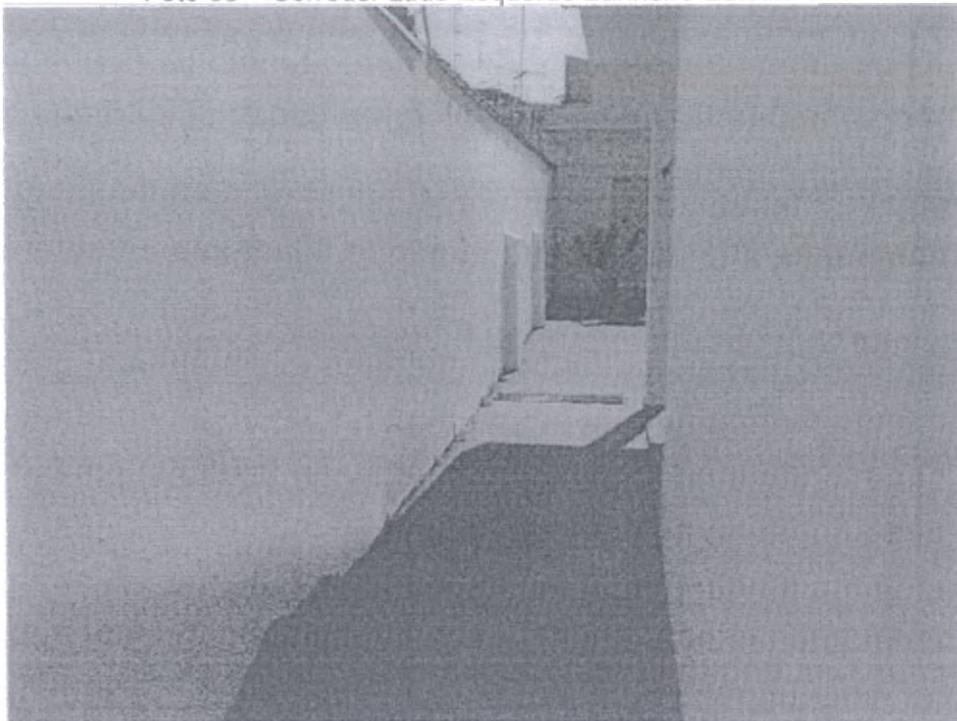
Iluminação Quintal Banheiro Edícula 1
